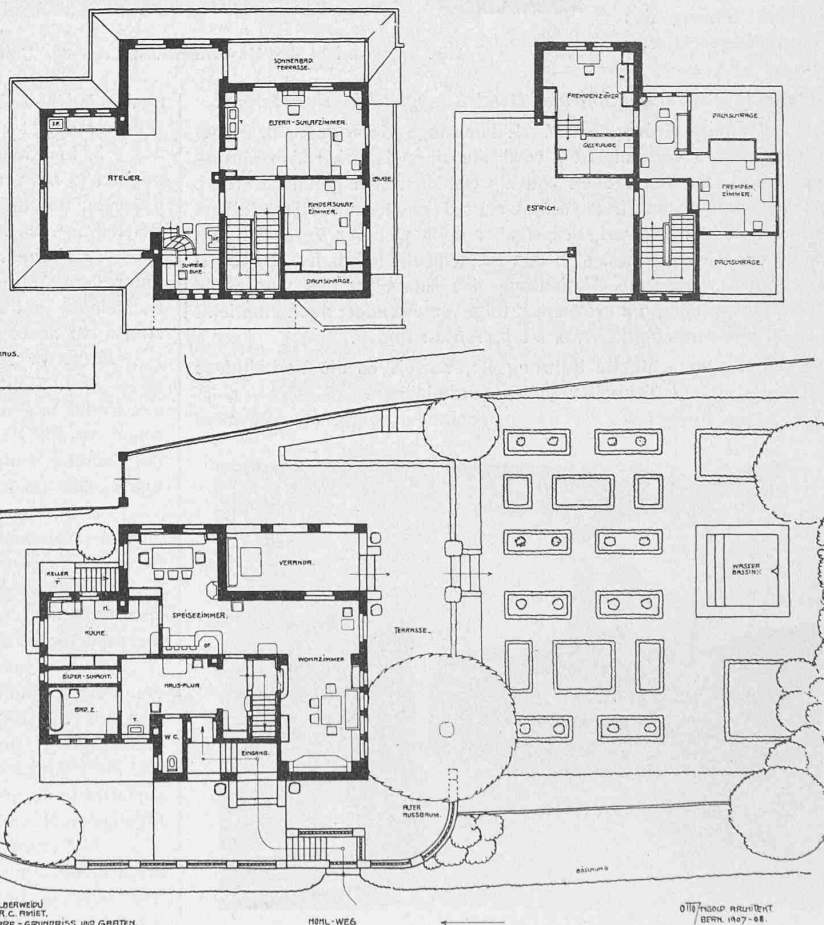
bis 3. Grundrisse vom Erdgeschoss, Obergeschoss und Dachstock. — Masstab 1 : 300.
